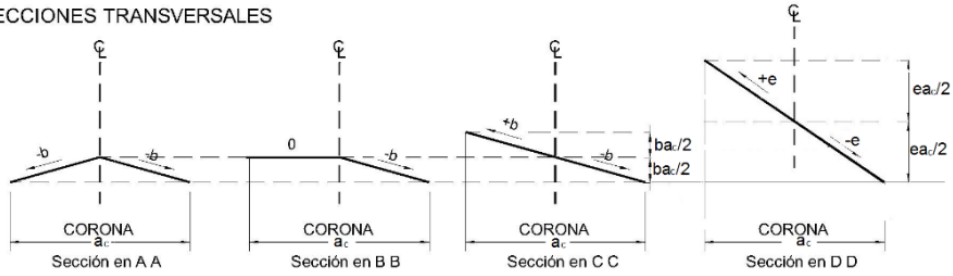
Transición de sobreelevación con giro sobre eje
